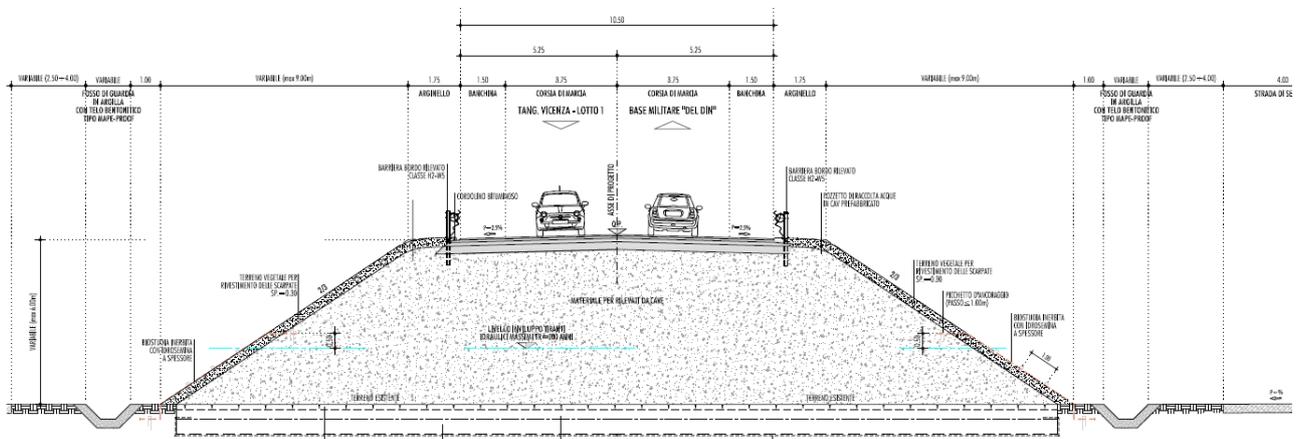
SEZIONE TIPO IN RILEVATO
